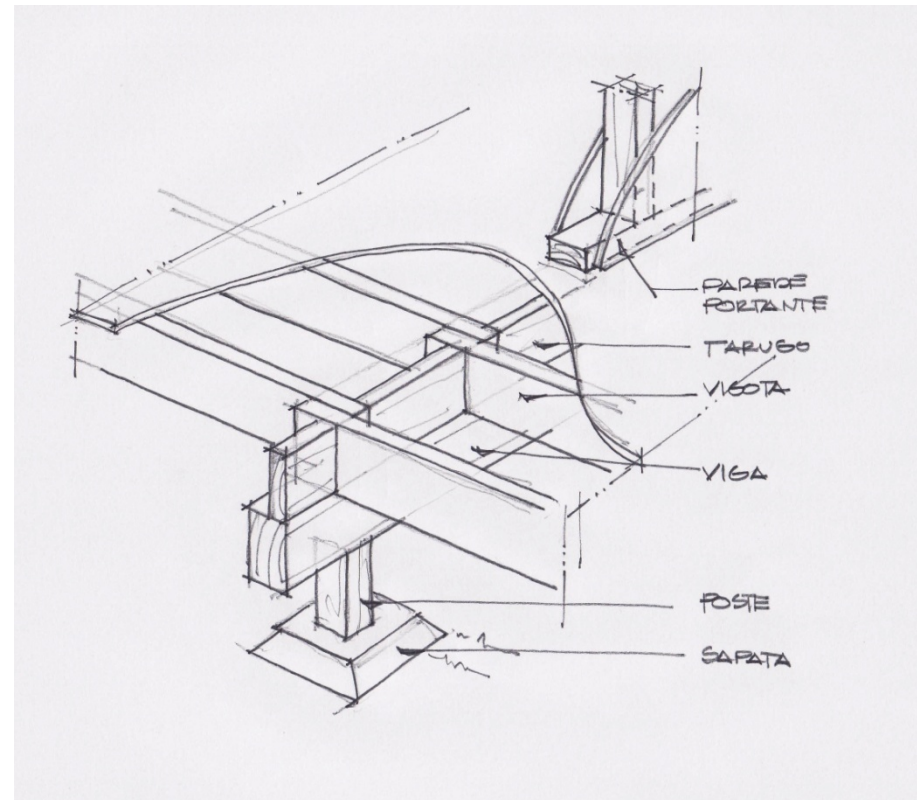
Alinhamento entre viga e parede interior. (des. autor)
